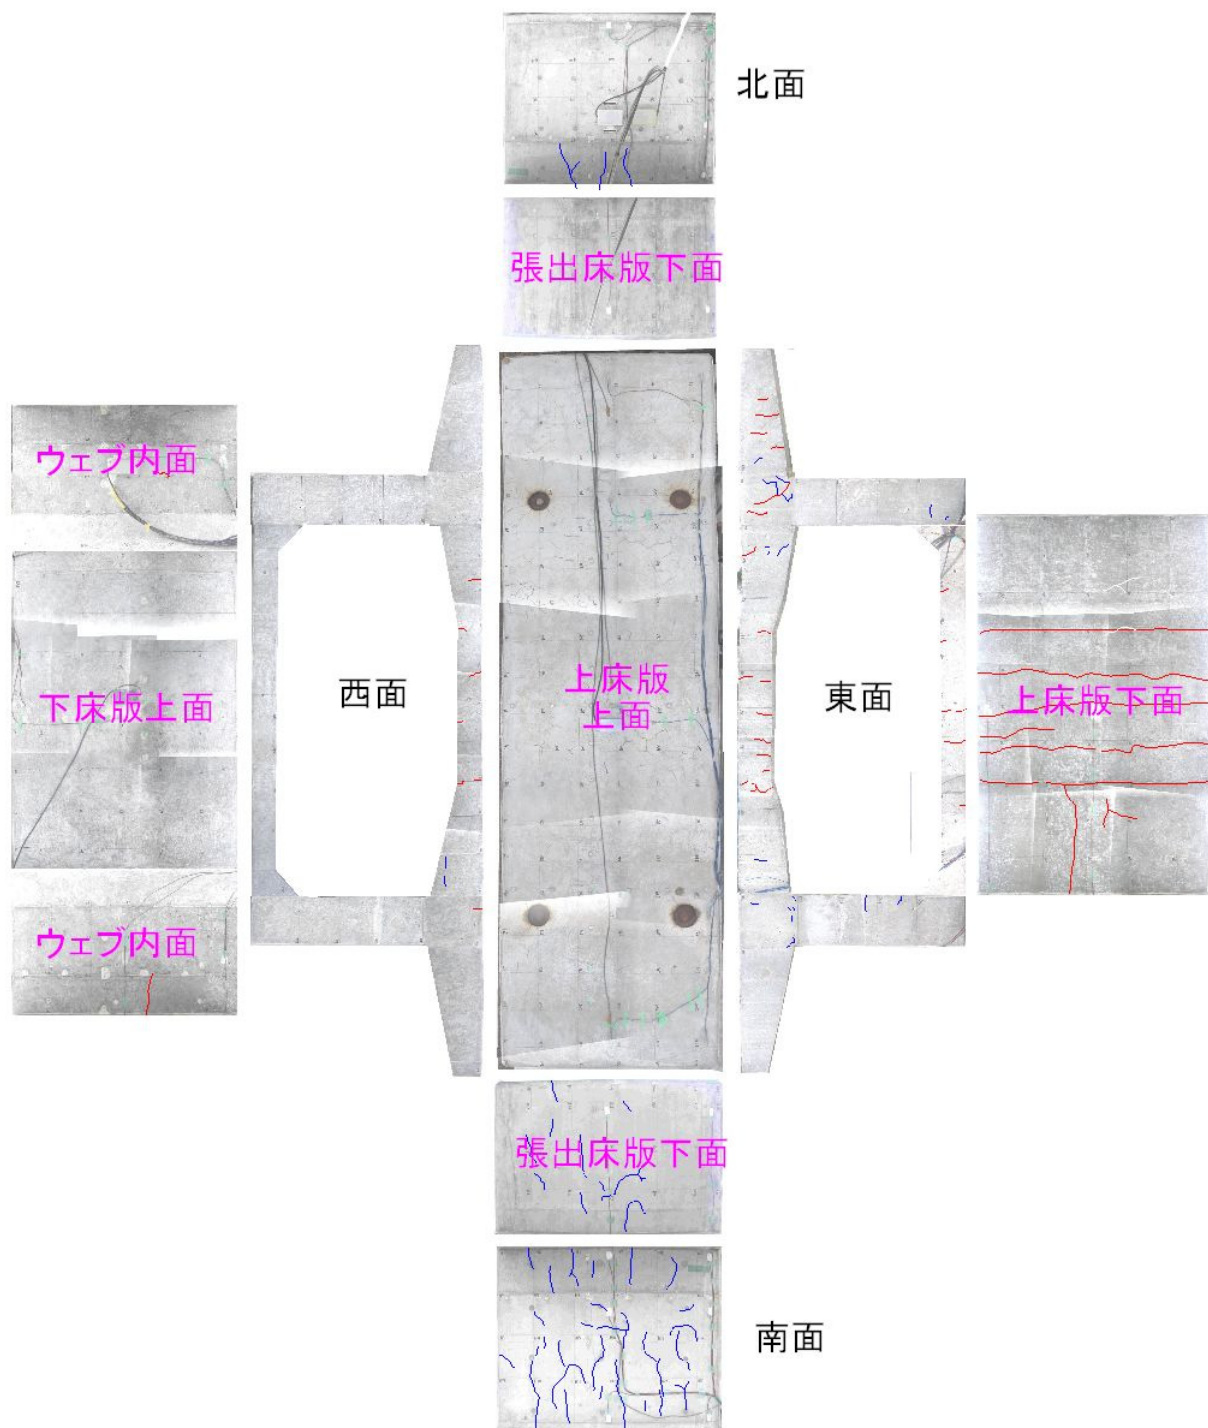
箱桁供試体 L1 ひび割れ状況 (2013 年 2 月撮影)
